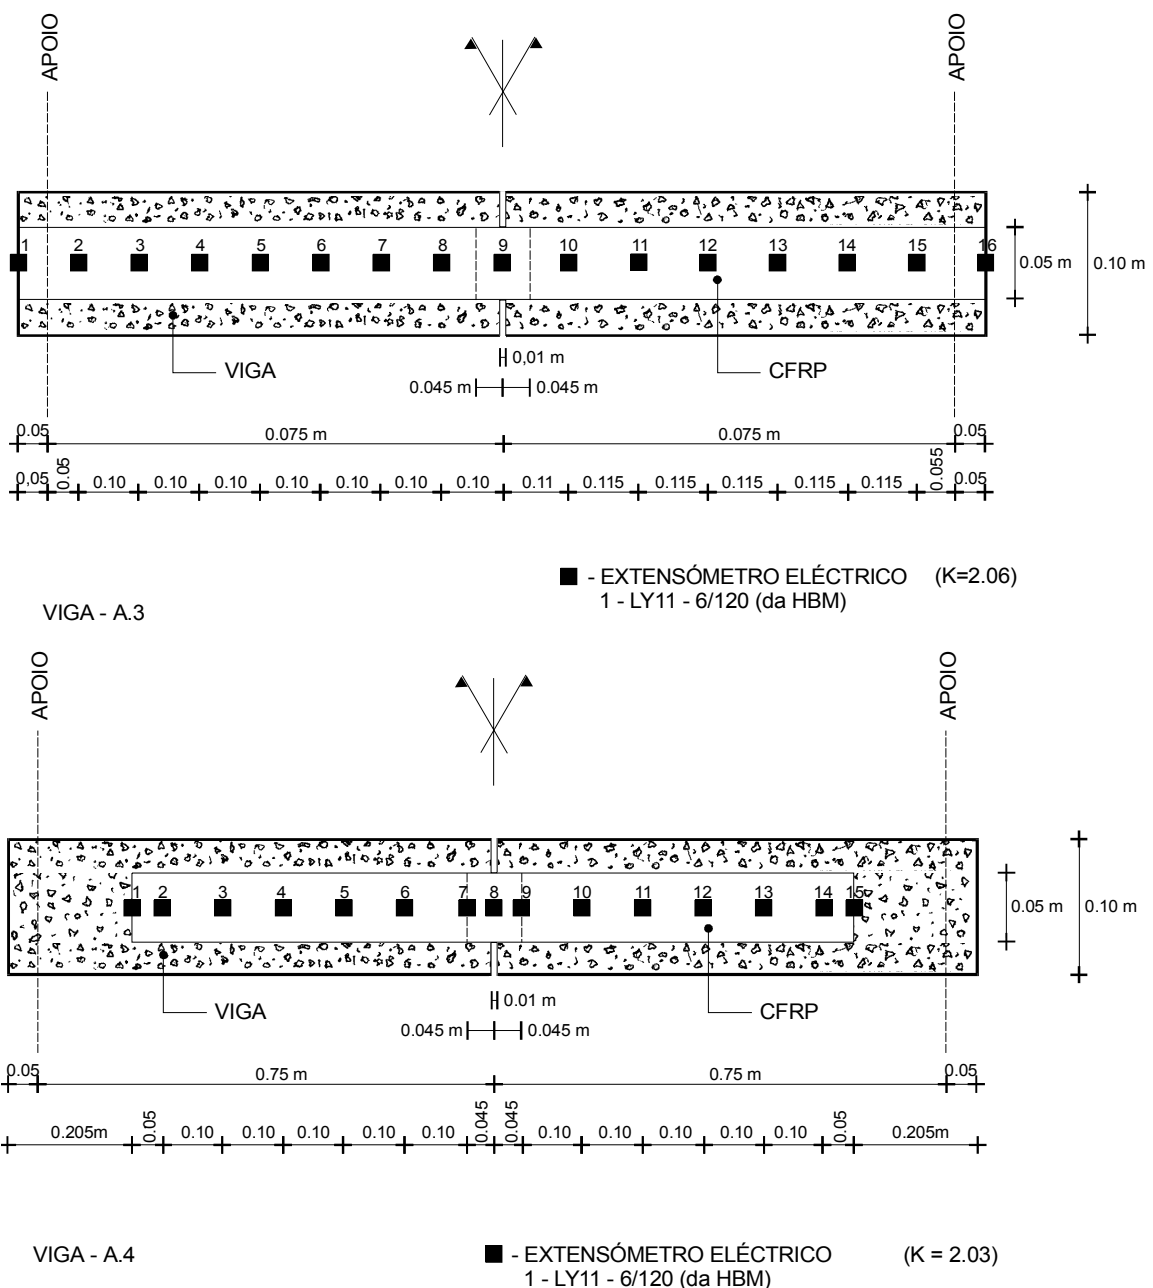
Plantas com a posição dos extensómetros eléctricos colados ao laminado de carbono (vigas A.3 e A.4).
